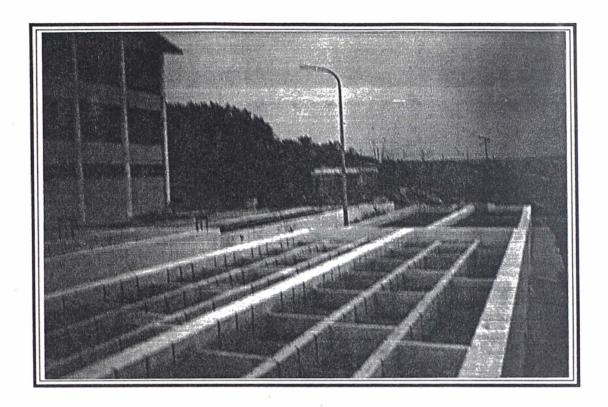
No existe cerco que delimite la propiedad de EMAPATUMBES y de la población. Se puede apreciar la facilidad de ingreso hacia las unidades de tratamiento.
